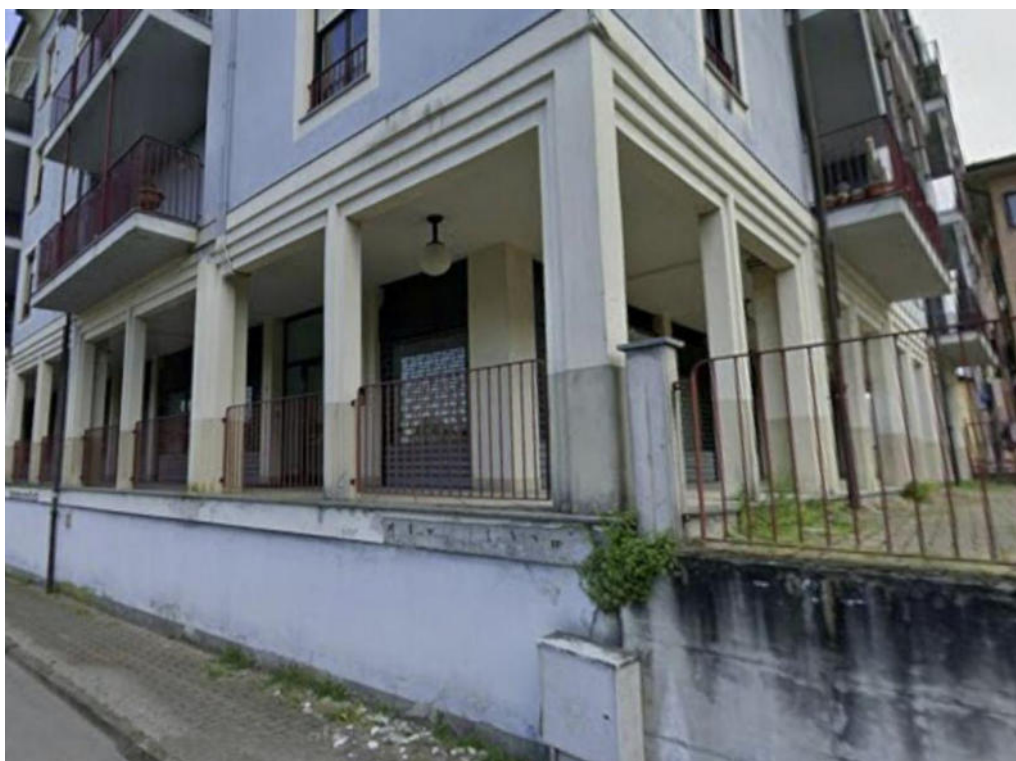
Prospetto nord Condominio “Azzurro Ventino”
